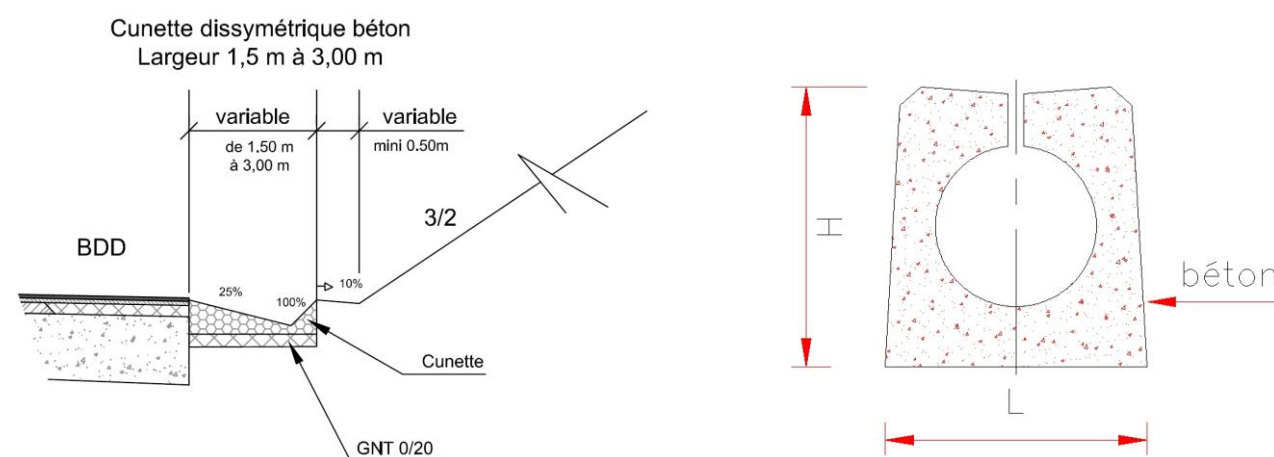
COUPES TYPES D'UNE CUNETTE BETON ET D'UN CANIVEAU A FENTE (DIMENSIONS DONNEES A TITRE D'EXEMPLE UNIQUEMENT)
